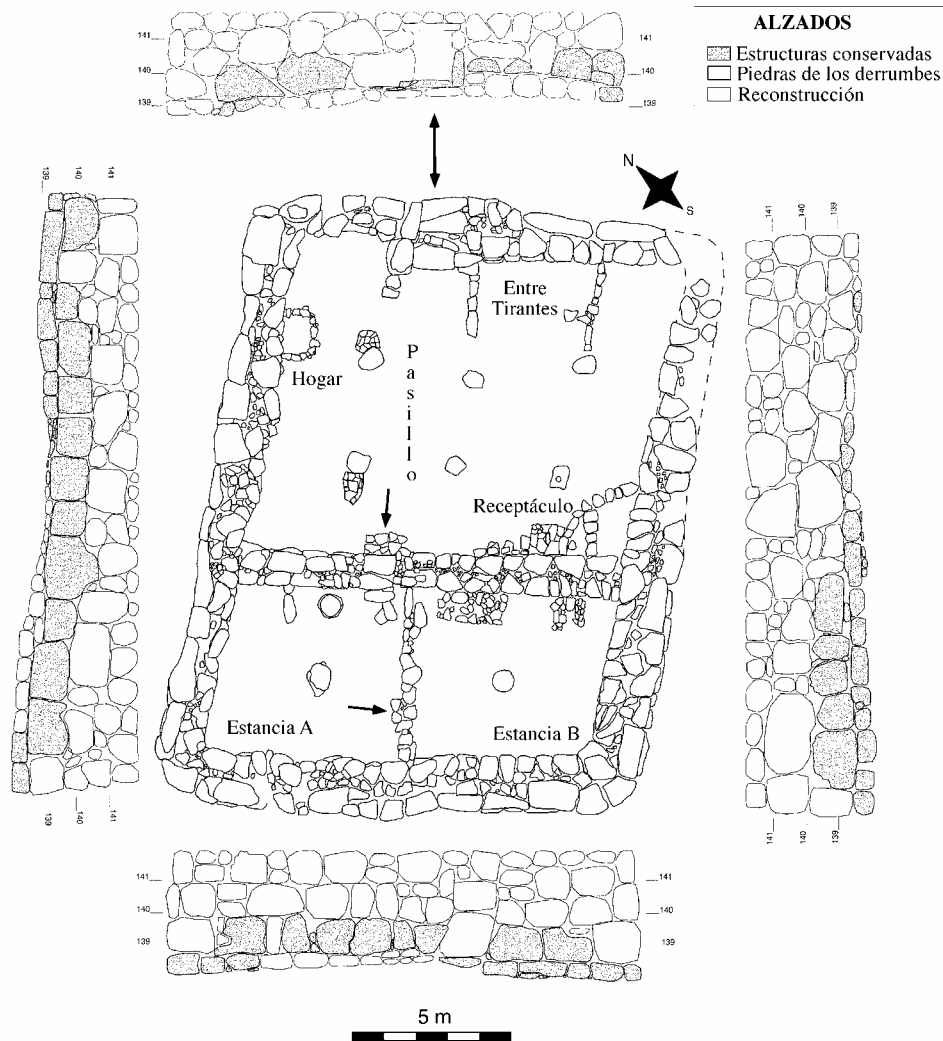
El Edificio Alfa. Planta y alzados de los paramentos exteriores.
